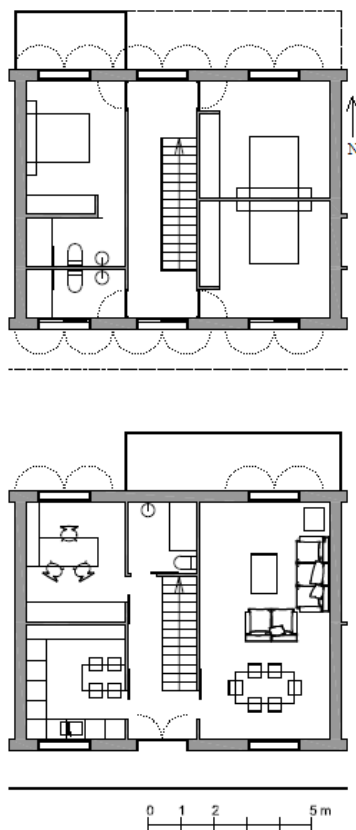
Planos de planta de la vivienda en bloque (dúplex).
